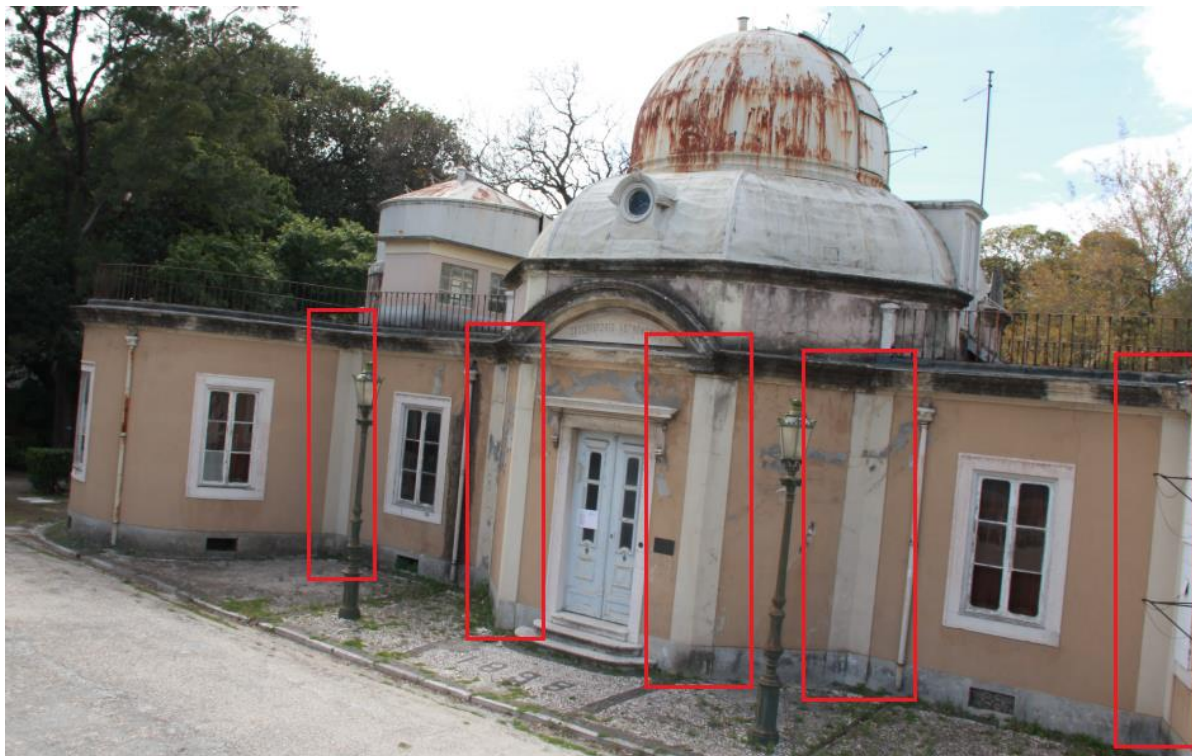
Conexões entre fachadas (destacadas a vermelho)
